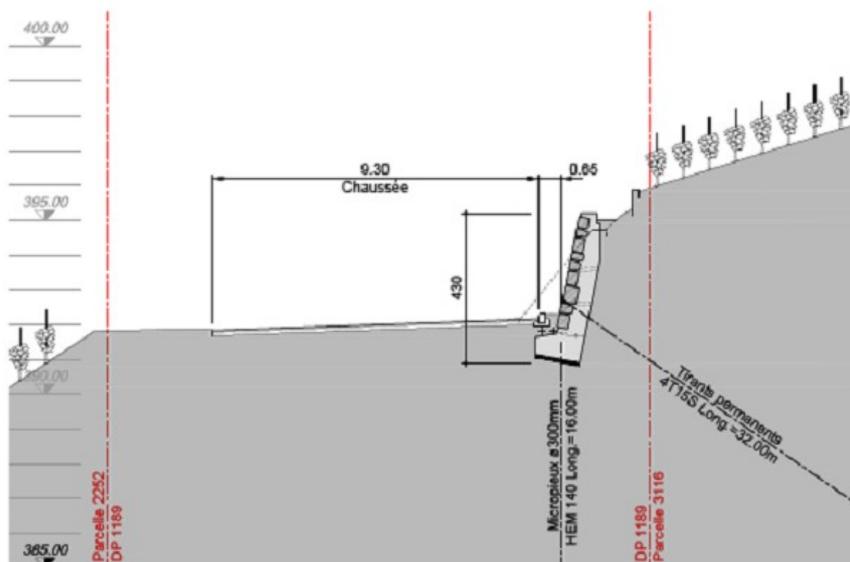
RC 780-B-P – Reconstruction du mur amont En Calamin
